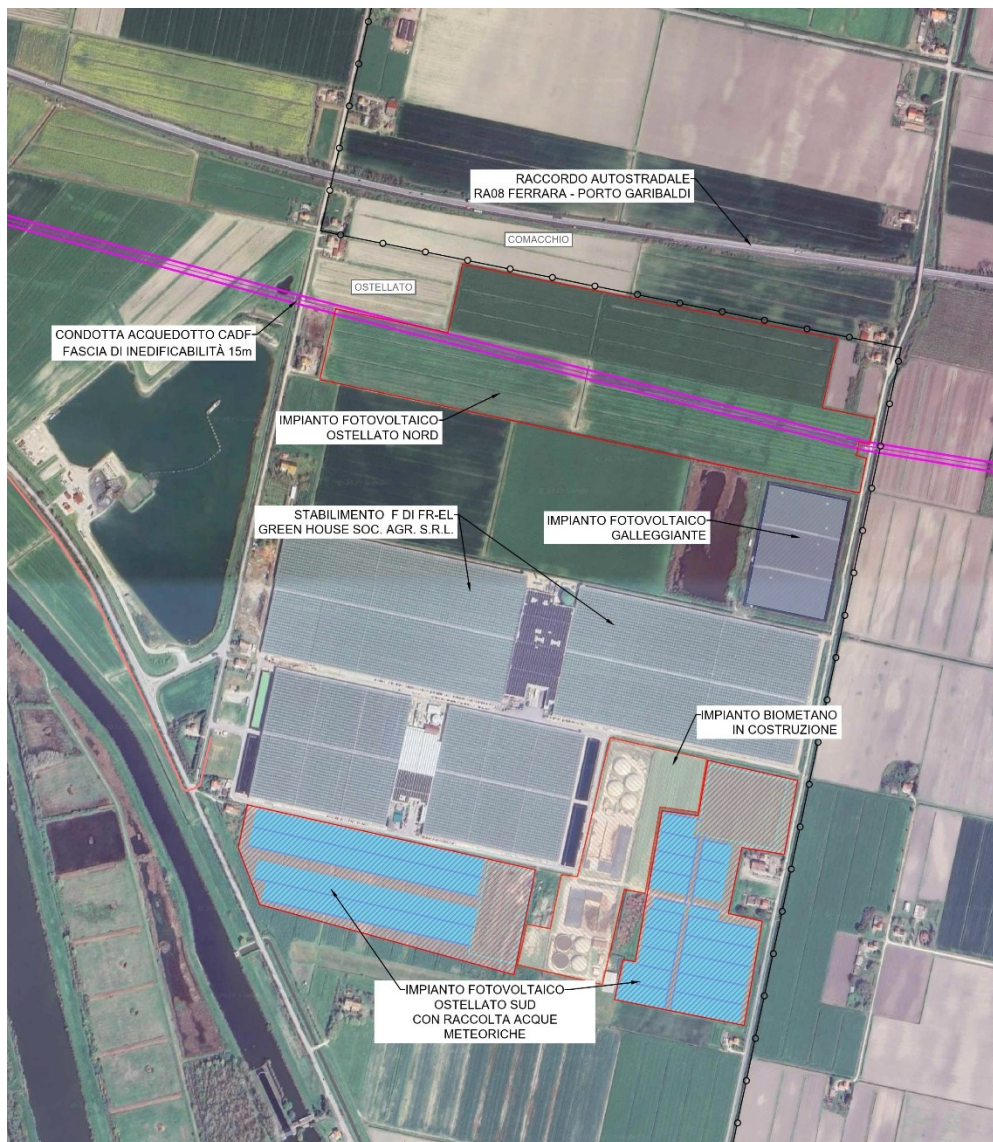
Planimetria satellitare area, IMPIANTI A BIOGAS e Serre
